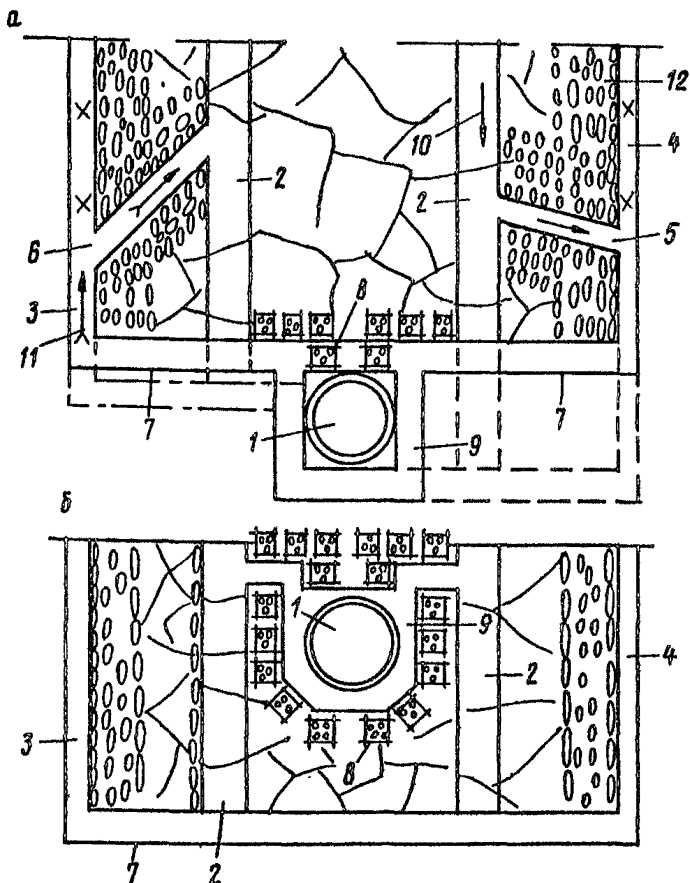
Схема проходки панельных бремсбергов широким ходом у пересечения пласта со стволом:
